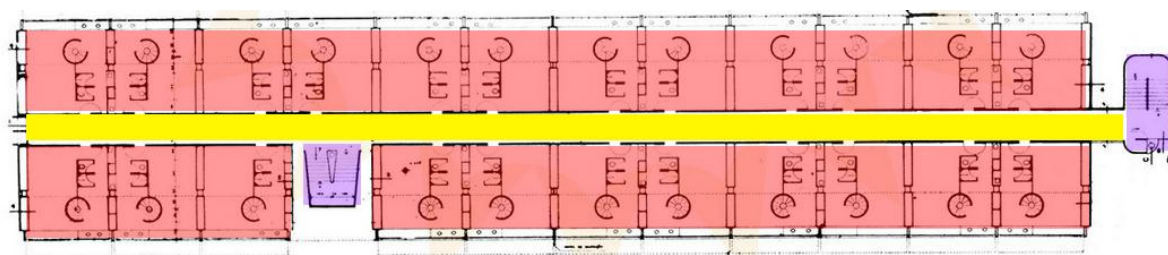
Planta 2o pavimento. Fonte: (ACROPOLE, 1970)
